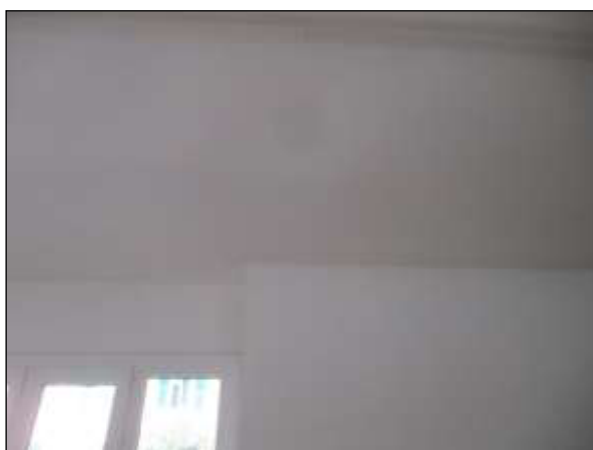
Porzione dell'intradosso del Corridoio al piano secondo connotata da una conservazione pessima.
